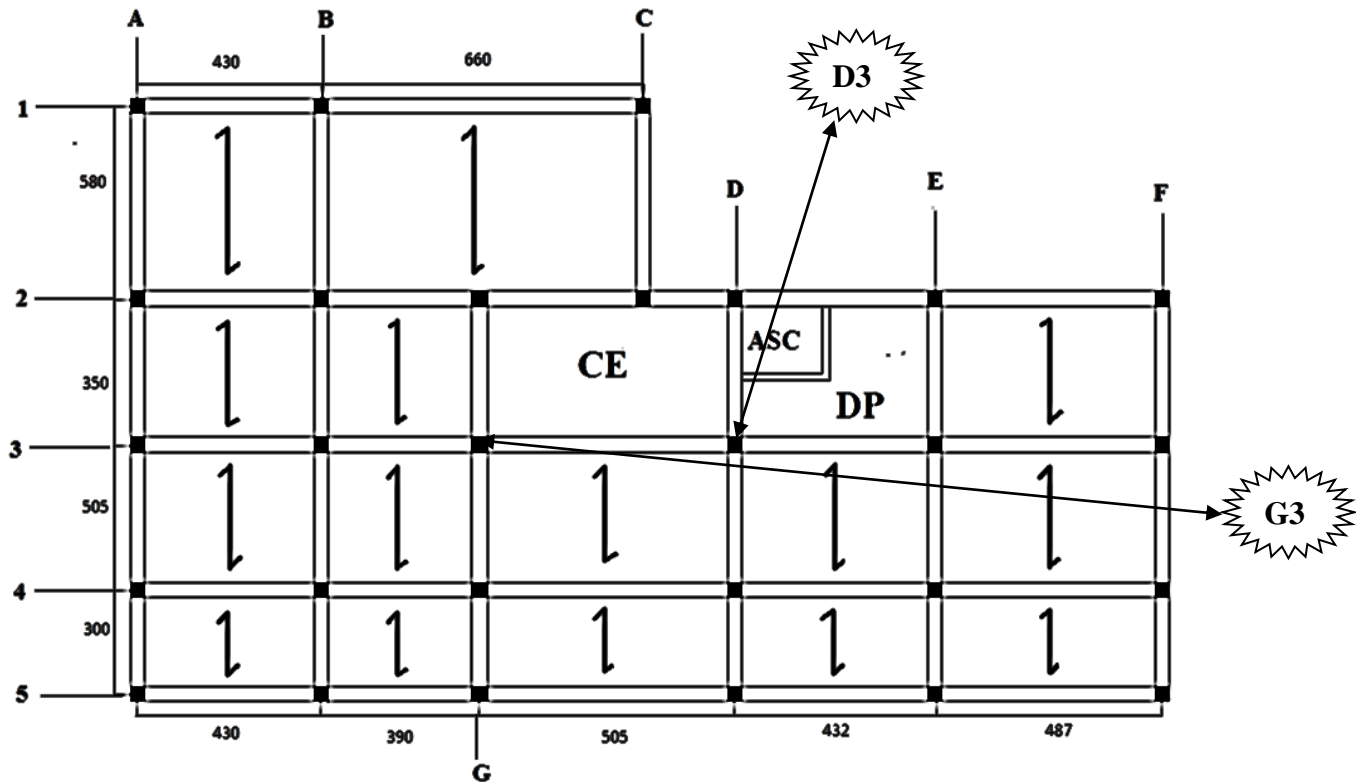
La disposition des poutrelles pour les étages courants.
